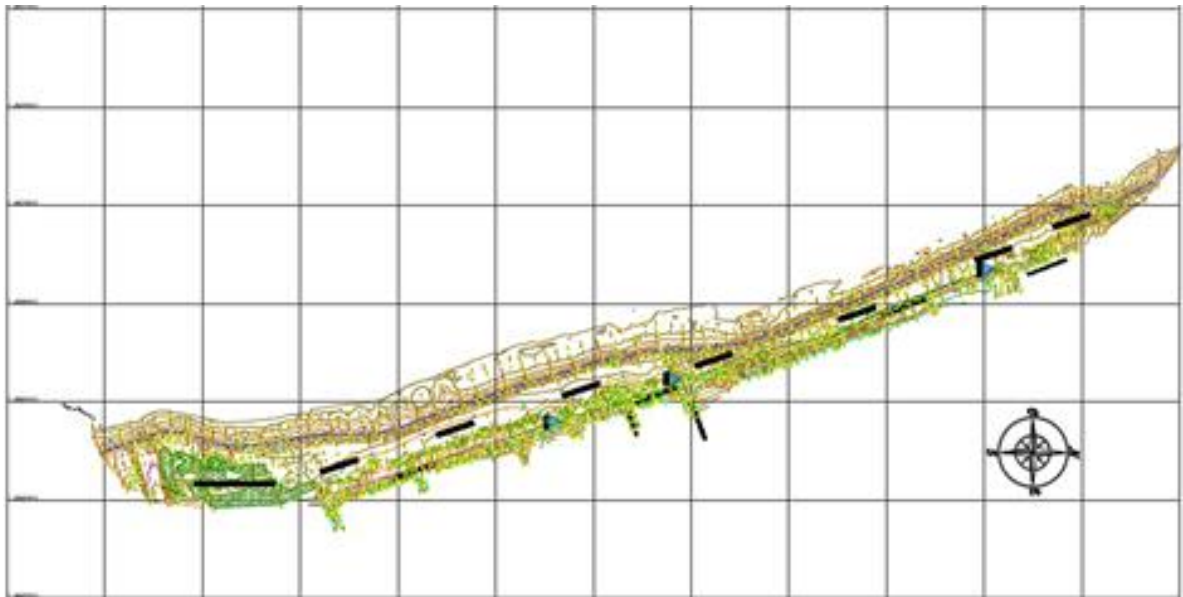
Vista de plano área levantada en el sector de Cascadas
